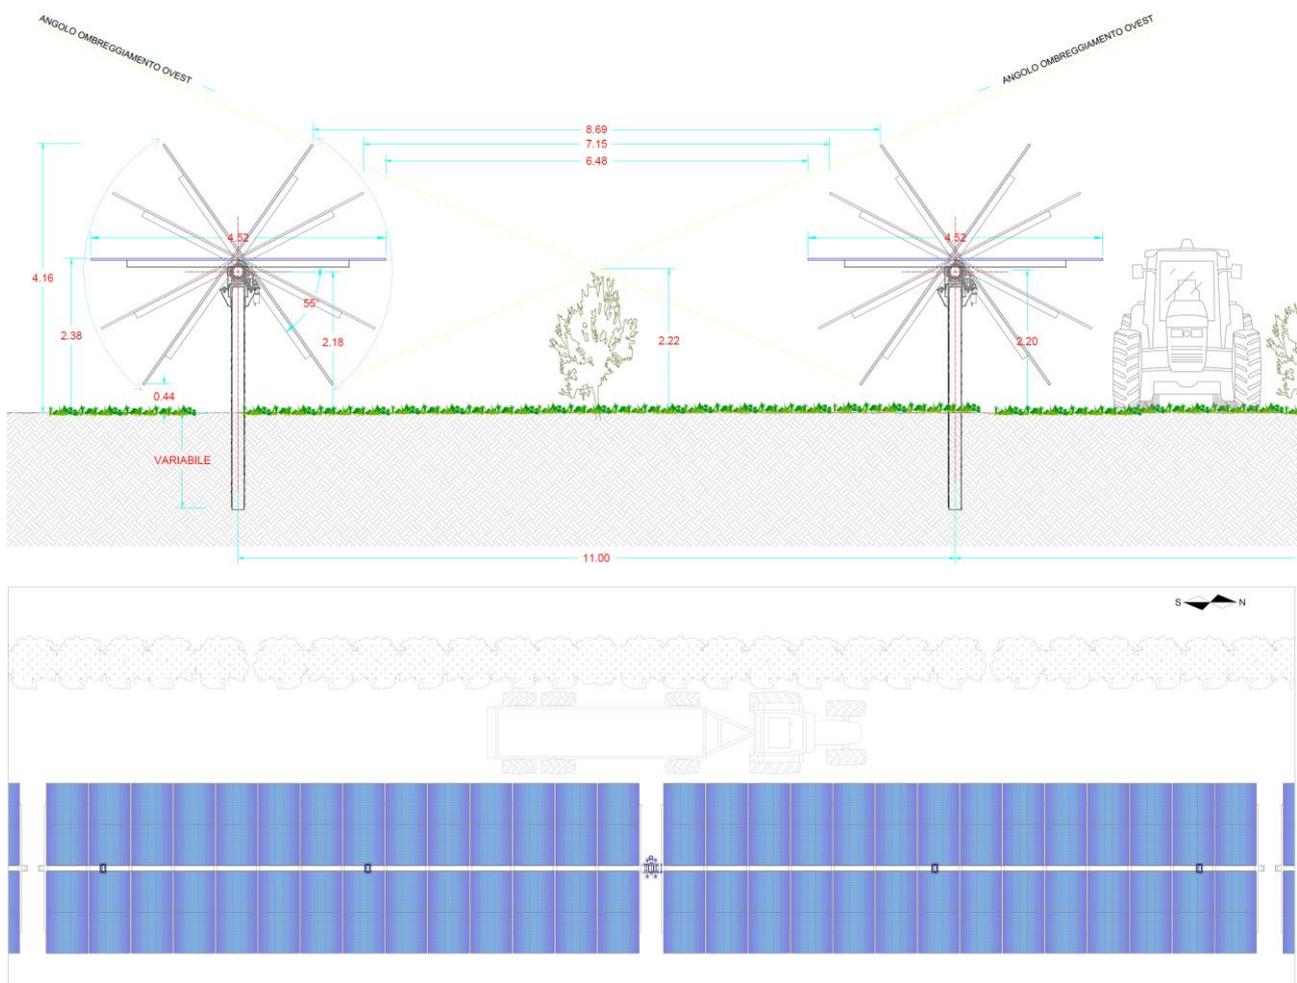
Prospetto trasversale (visione est-ovest) e in pianta delle strutture dell'impianto fotovoltaico integrata con gli ulivi super intensivi interfila
